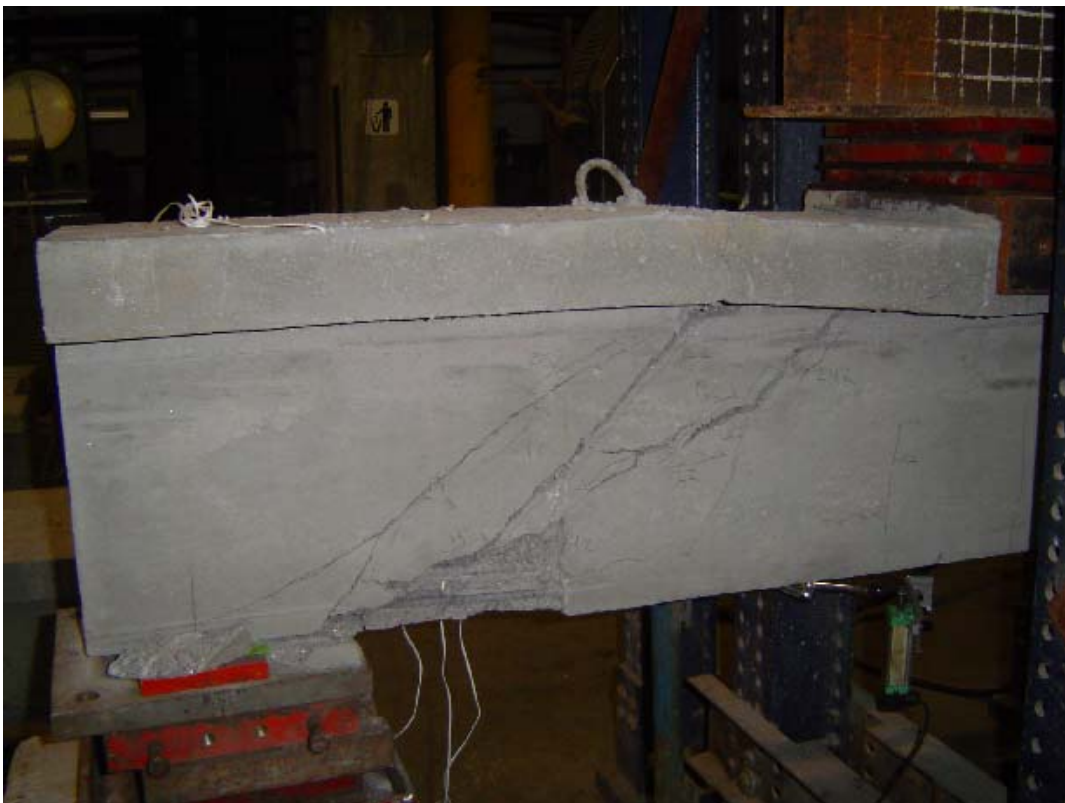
Detalhe da ruptura da viga VR2 (2).
